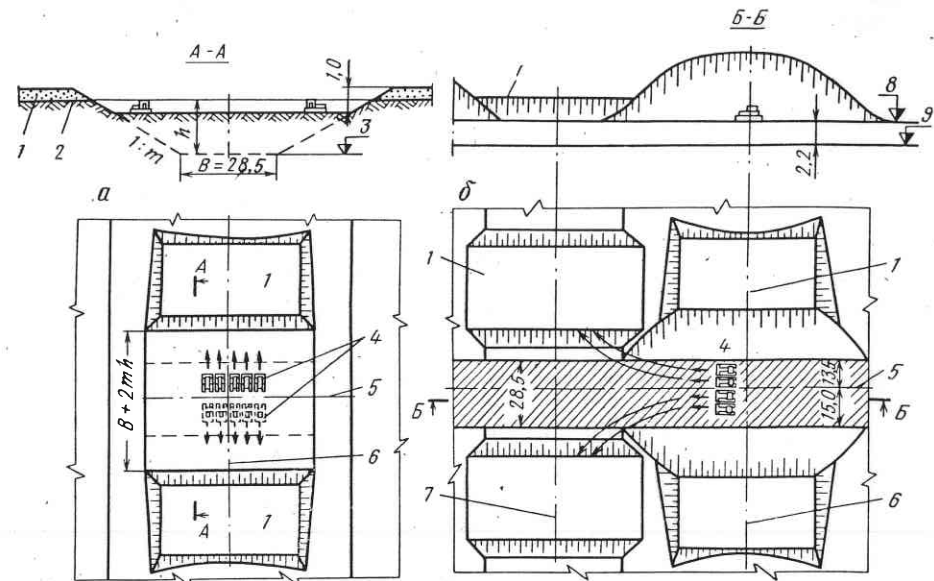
Разработка грунта бульдозерами по схеме Гипрогаза:
